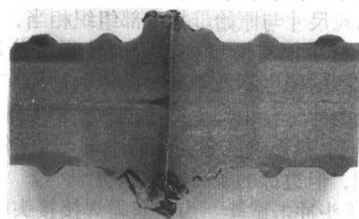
闪光对焊接头纵剖面宏观形貌
